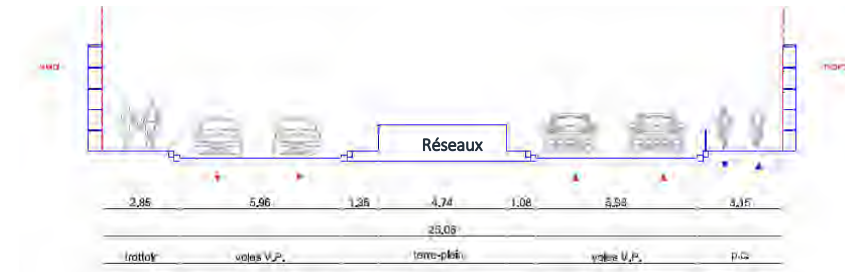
Coupe en travers de l'ouvrage OA1 actuel
